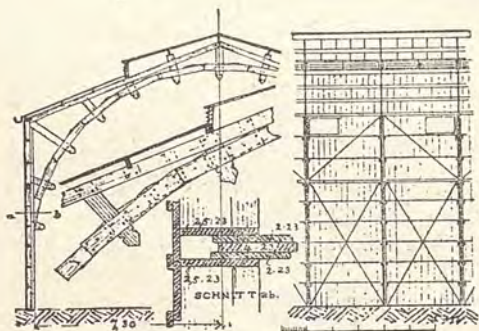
Armatura della galleria della Pesca all'Esposizione di Londra del 1883.
